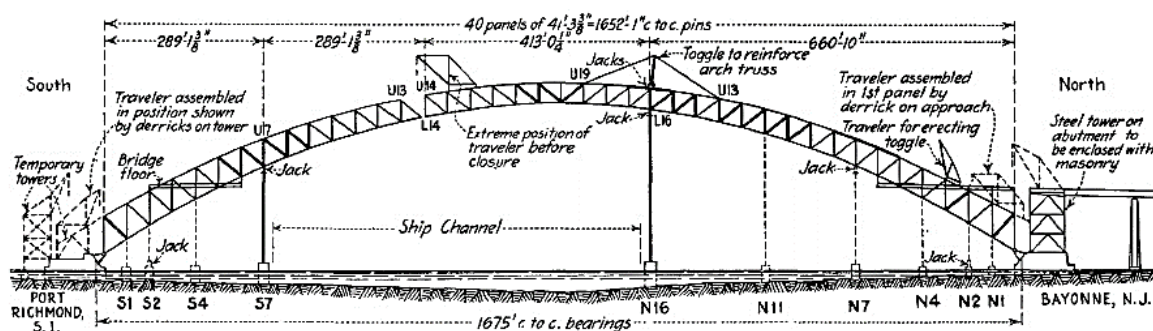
Esquema da construção do arco metálico da Bayonne Bridge [6].
